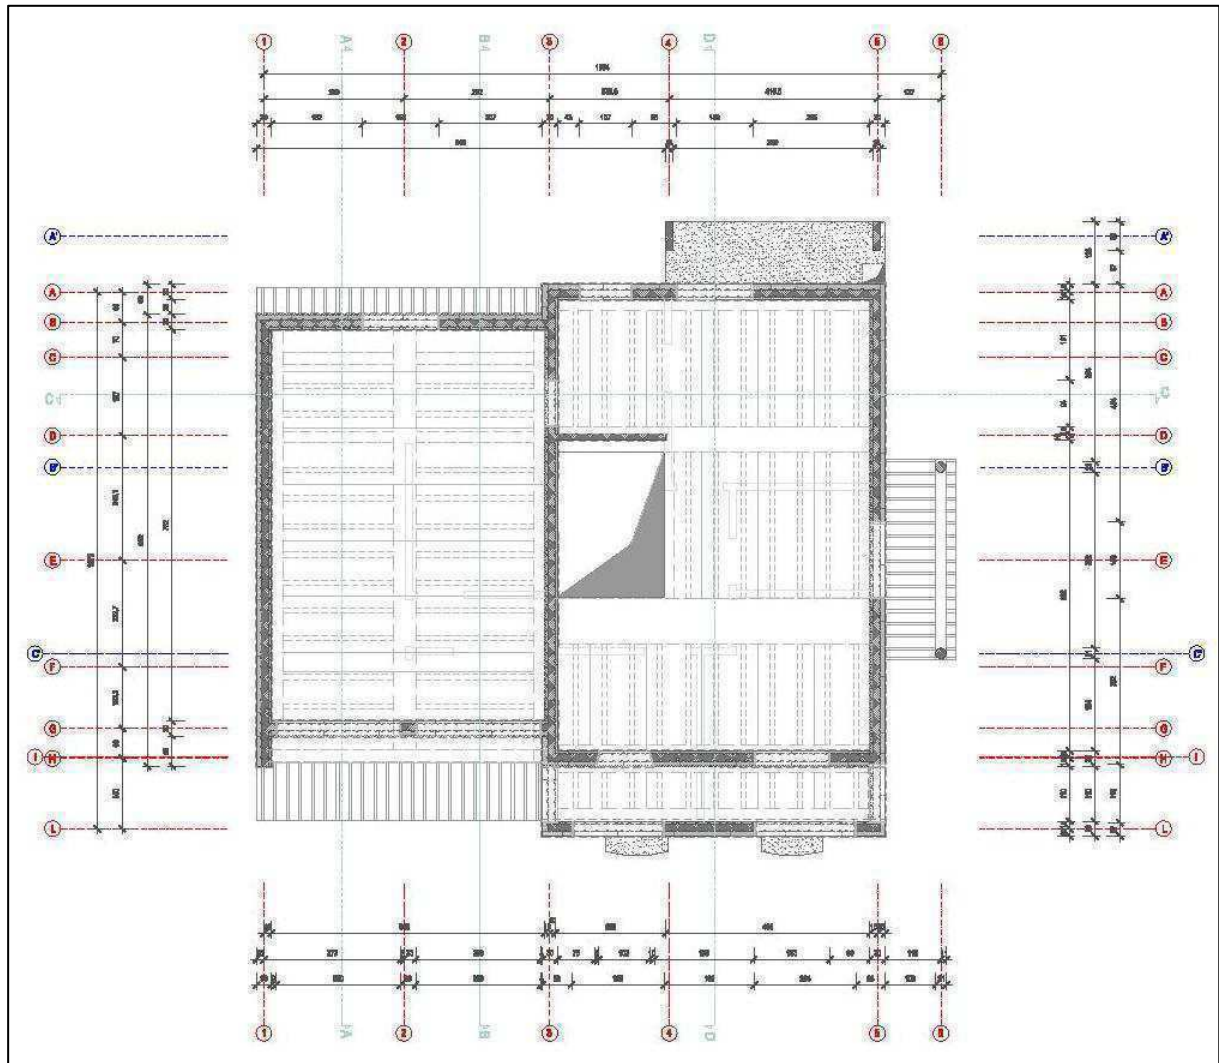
Pianta Piano Terra – Murature – Carpenterie; Tavola 3.
